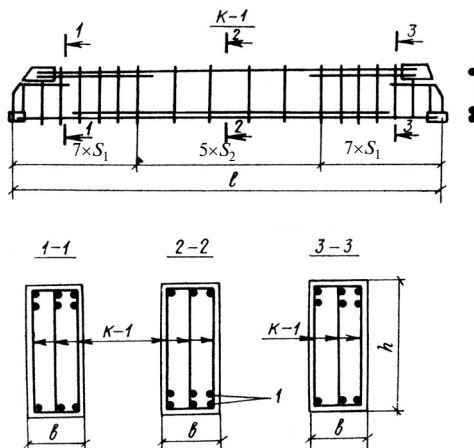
Схема армирования прогона плоскими сварными каркасами: *a* — плоский сварной каркас; *b* — поперечные сечения прогона
